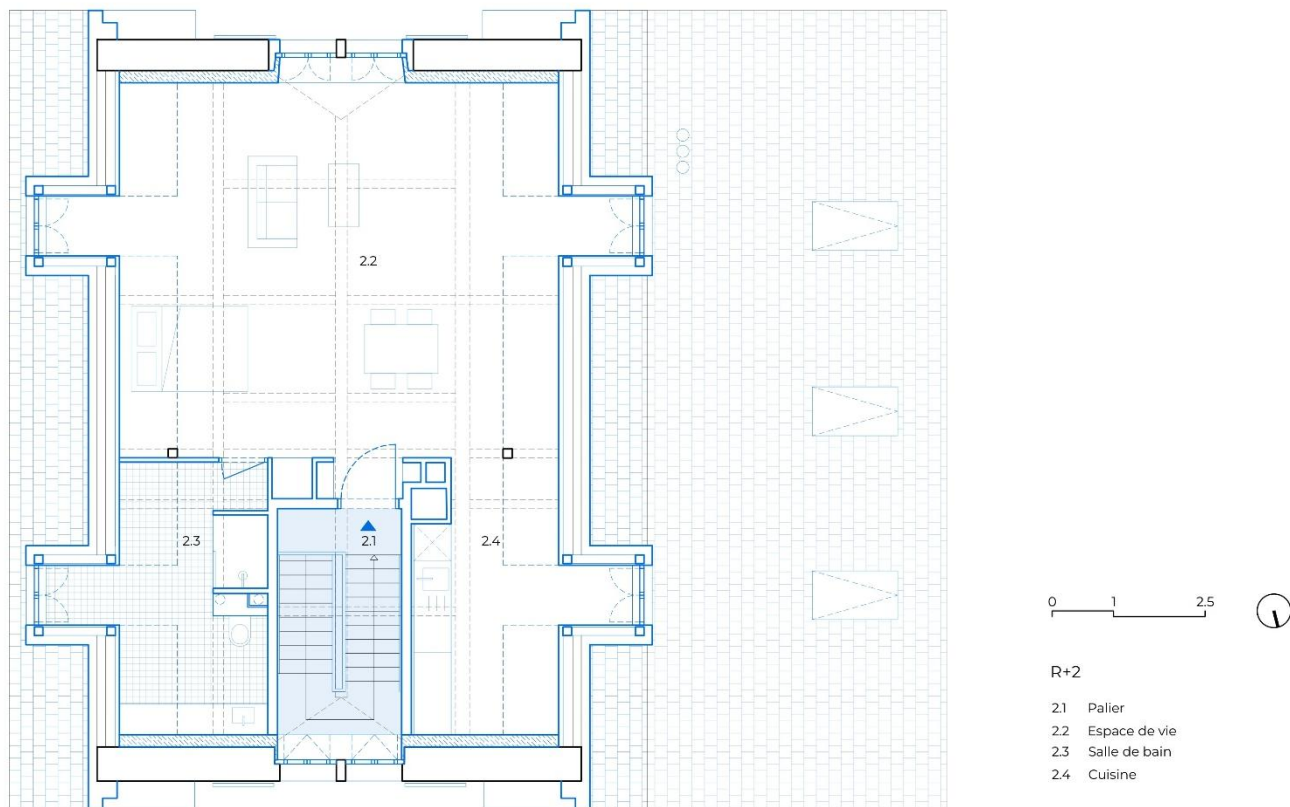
Plan projet R+2 (source Mayker Architectes)
